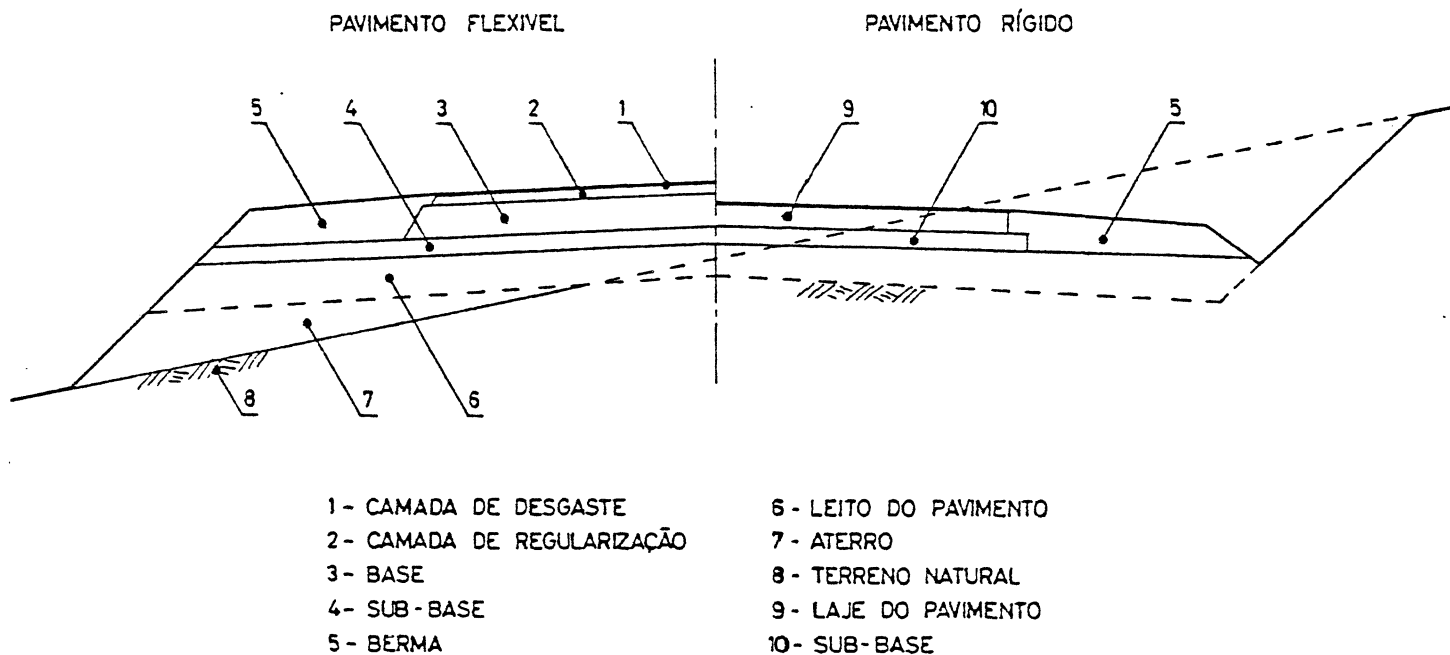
COMPOSIÇÃO TÍPICA DOS PAVIMENTOS
